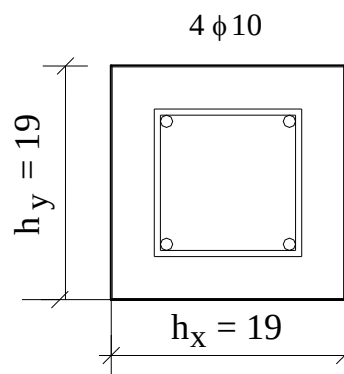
Detalhamento da armadura na seção transversal do pilar P6.
